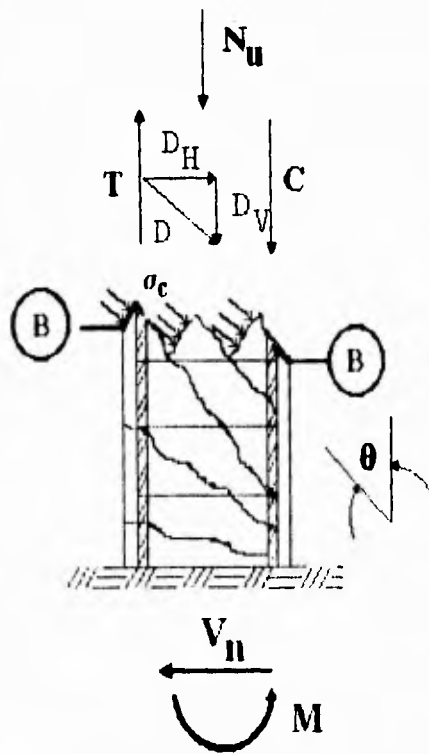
Corte B-B de la figura 11.2 donde se muestra las fuerzas que actúan en el concreto de la columna
